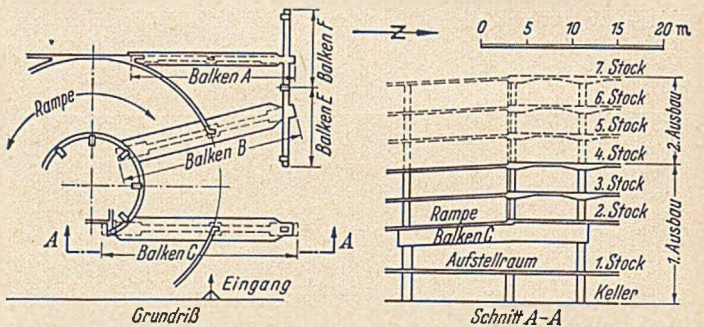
a) Grundriß, b) Schnitt des Garagenbaues mit den Abfangbalken A—F über dem Aufstellraum.
